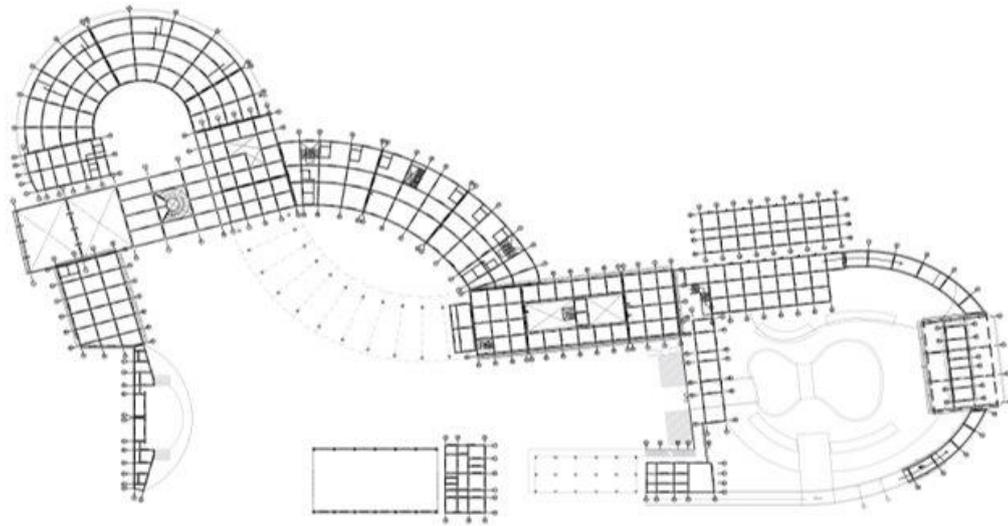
Figura SEQ Figura * ARABIC 97 : Plano estructural Segundo Nivel
